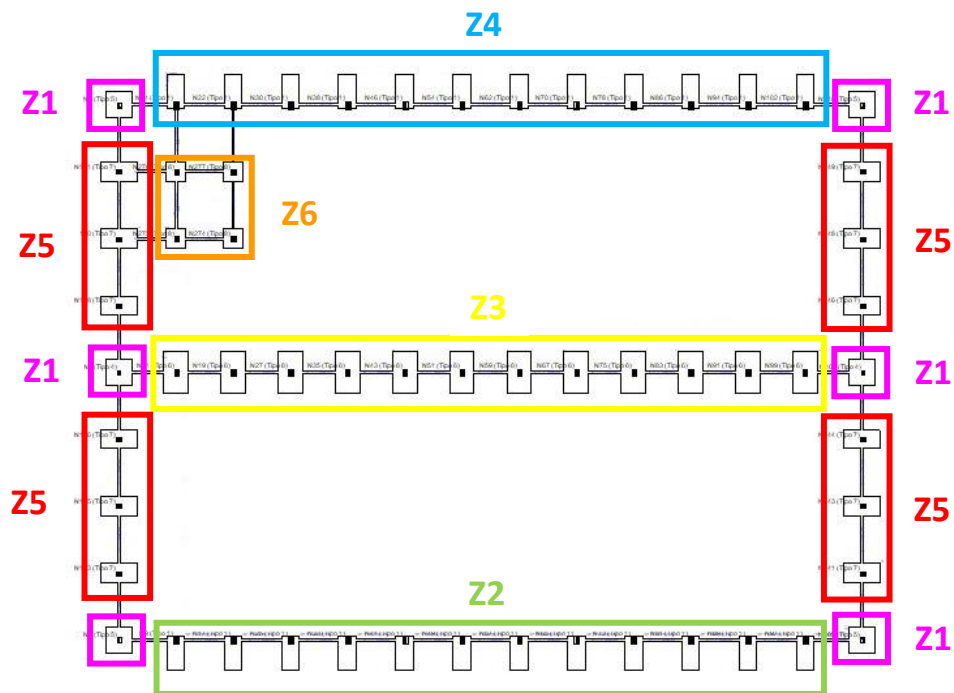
Disposición de las zapatas. Fuente: CYPE 3D.
